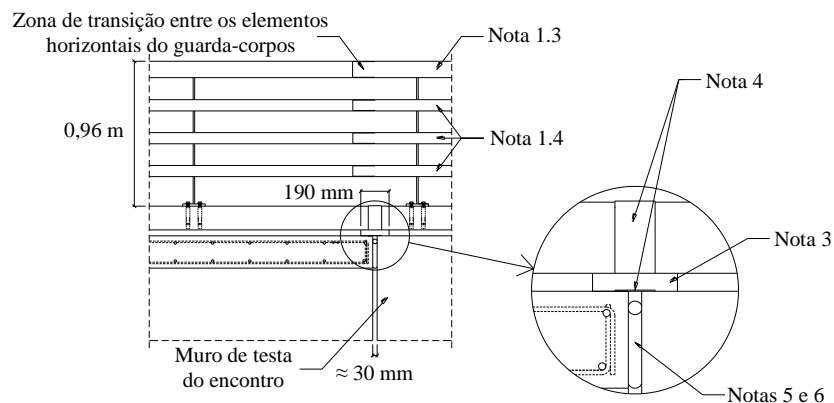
Secção longitudinal dos guarda-corpos e juntas de dilatação (secção AA).
